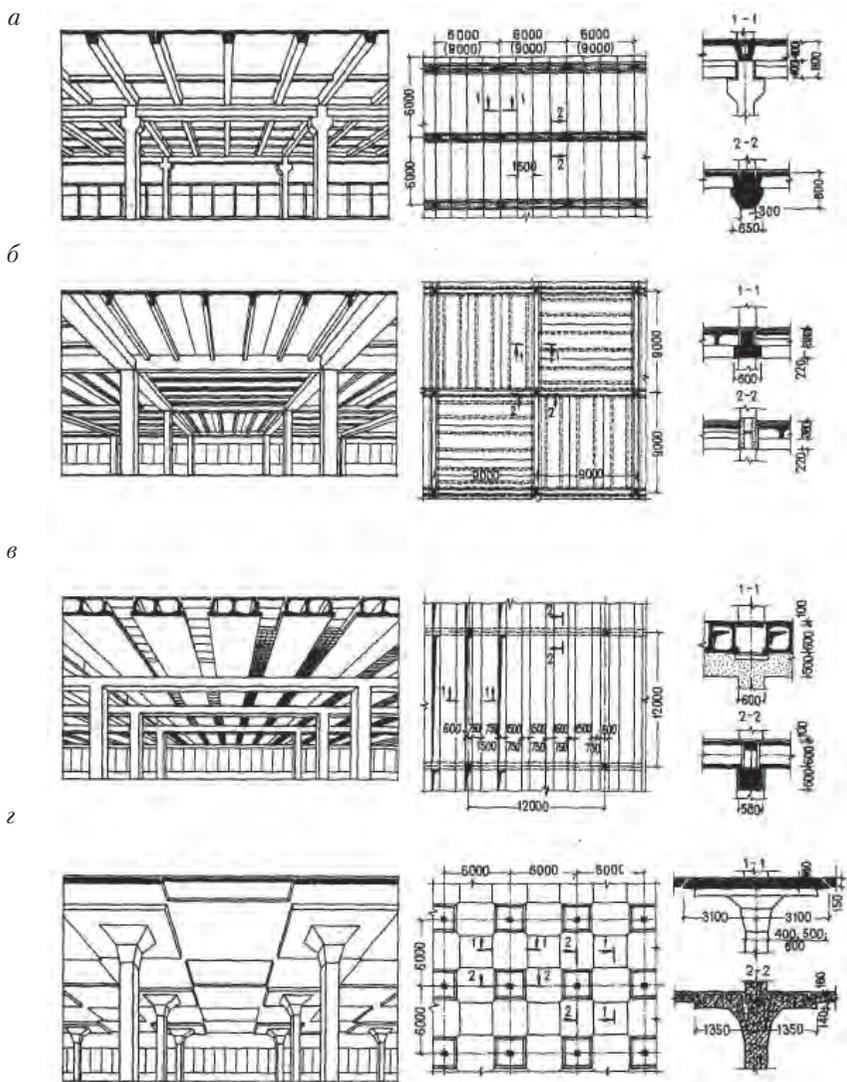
Конструкции многоэтажных промышленных зданий без технического этажа:
